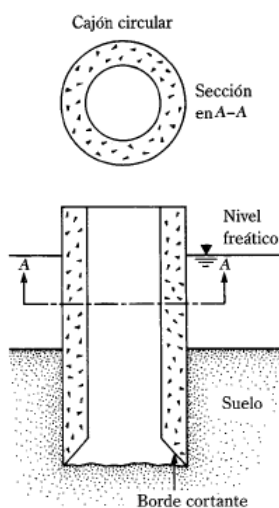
"Cajón circular en planta y corte". Fuente: Braja Das (2001), *Fundamentos de ingeniería de cimentaciones
